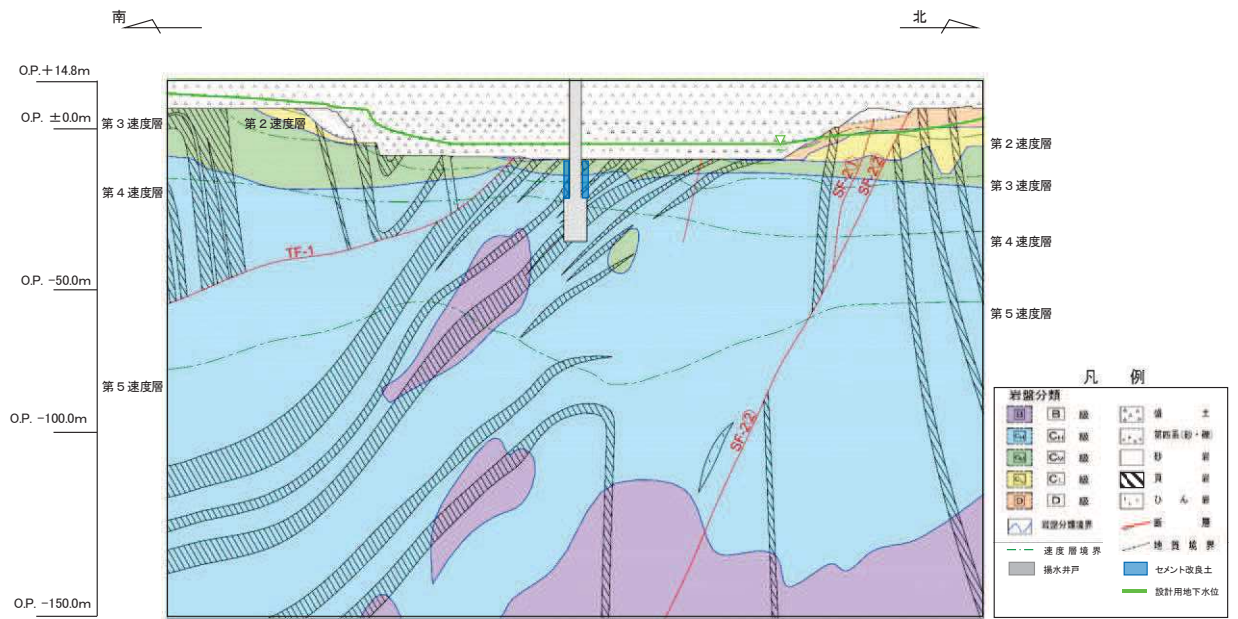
(2) No.2 揚水井戸 評価対象断面図 (B-B' 断面)
